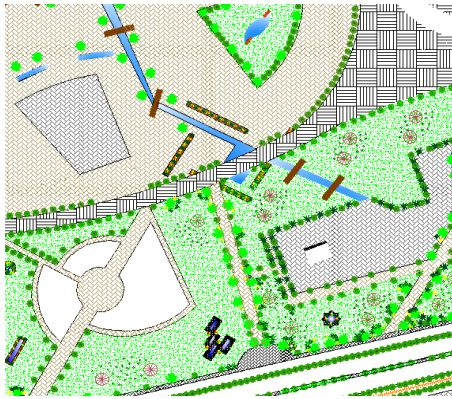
Vue en plan de l'aboutissement de la trame verte et la trame bleu
